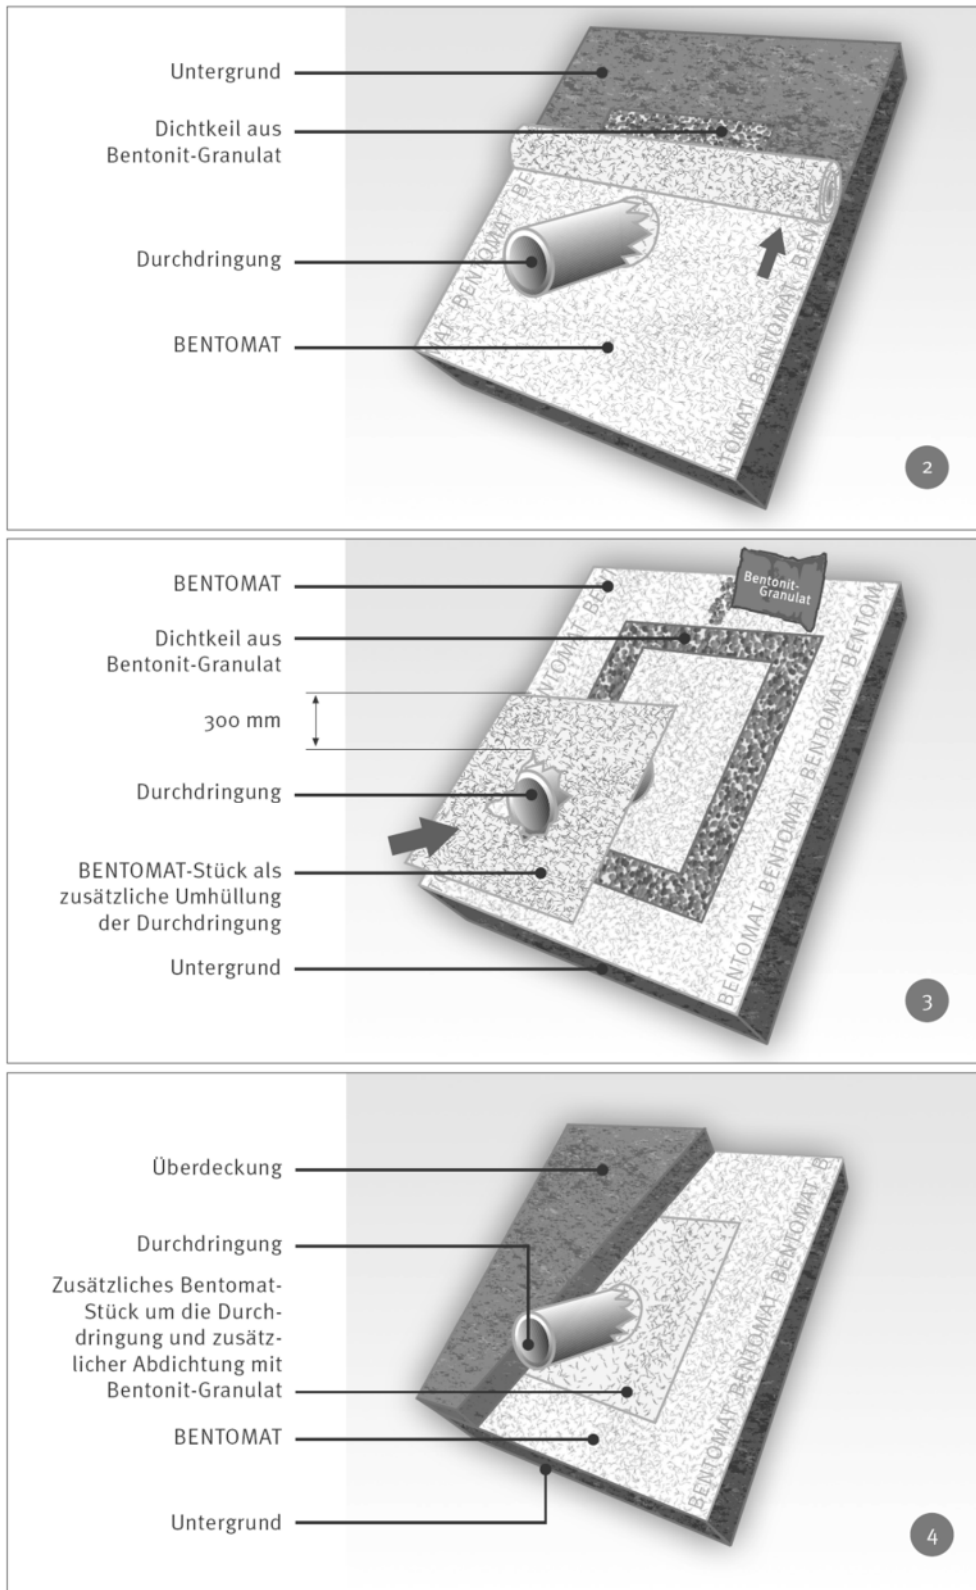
6.4: Schemazeichnungen für Ausführung von Durchdringungen
